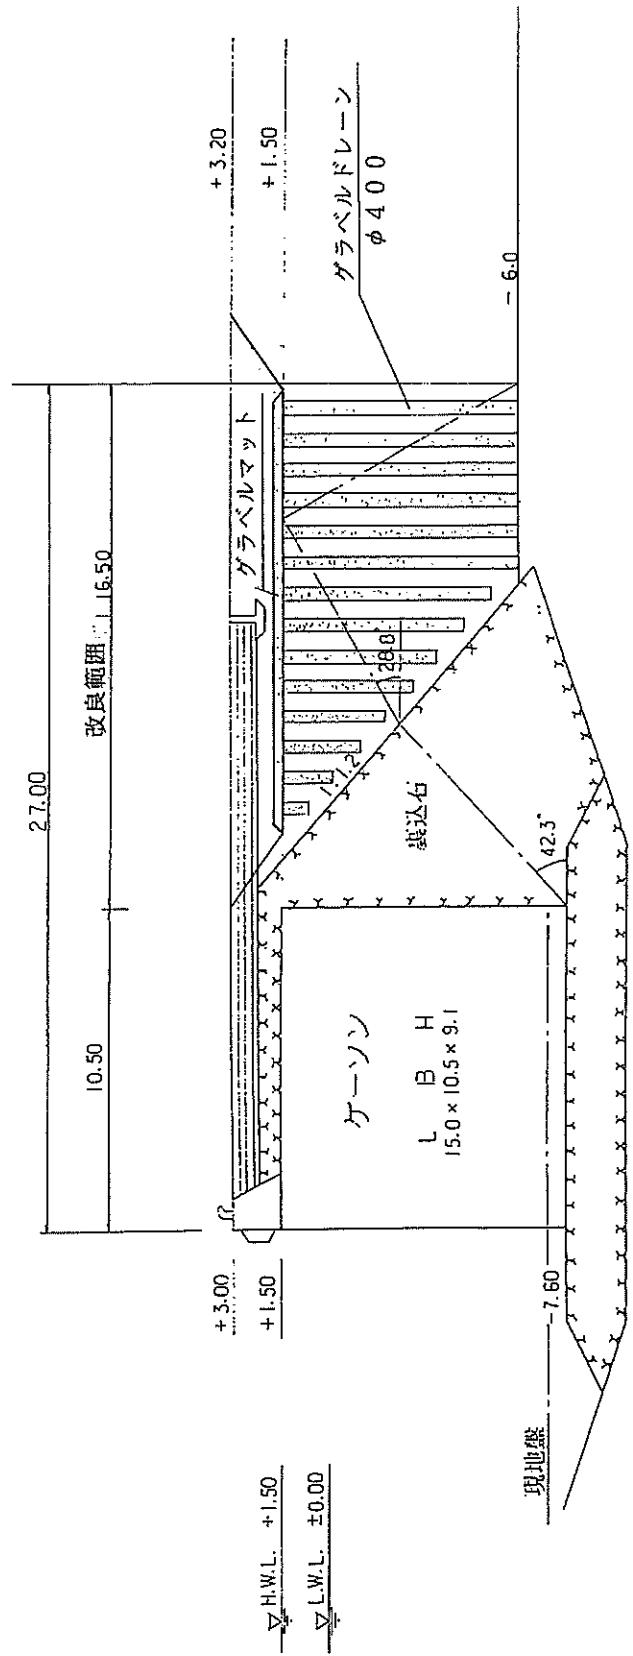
西港区第二埠頭地区⑦西侧岸壁 (-7.5m) 浪状化对策断面図
